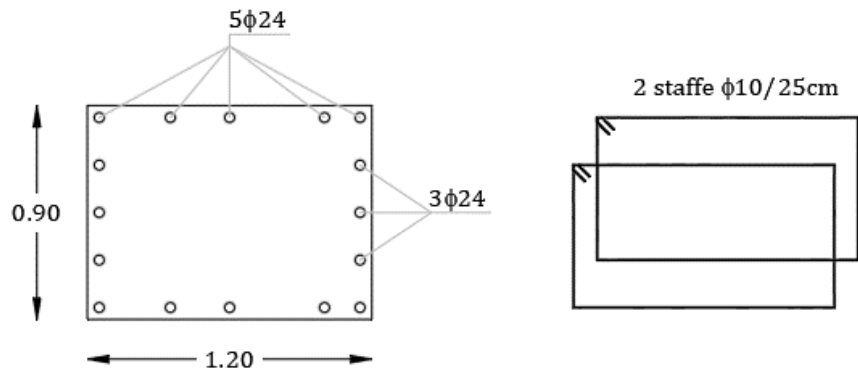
Sezione del piedritto e disposizione dell'armatura (piano x-y)
